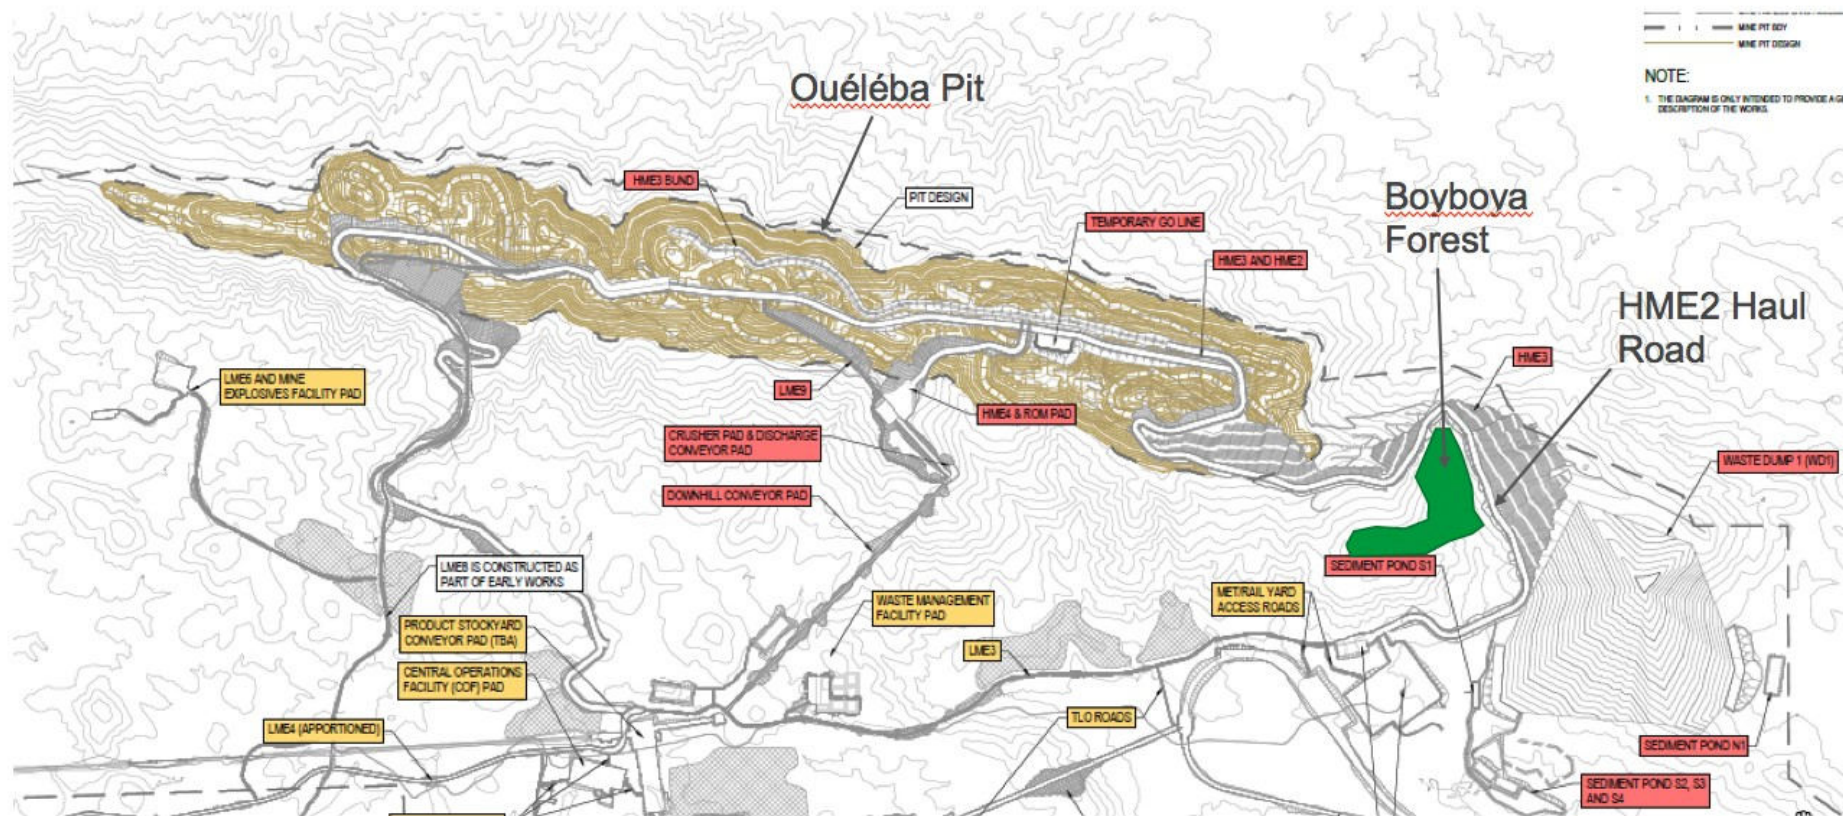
Situation générale de la forêt de Boyboya et du plan minier de Ouéléba (nord à droite)
